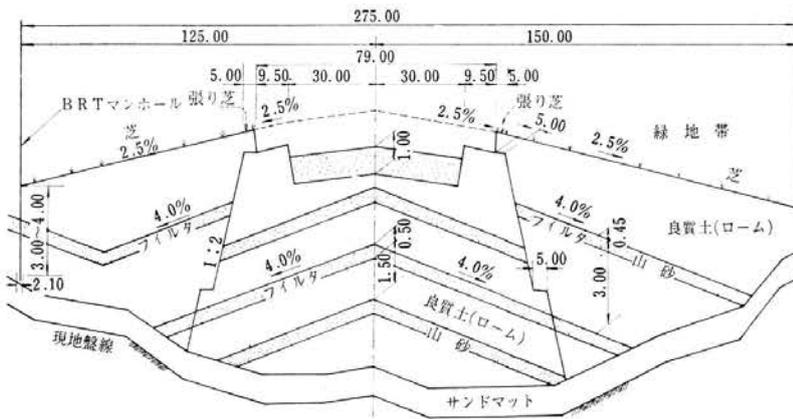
フィルタ工A滑走路標準横断面図(盛土部)
